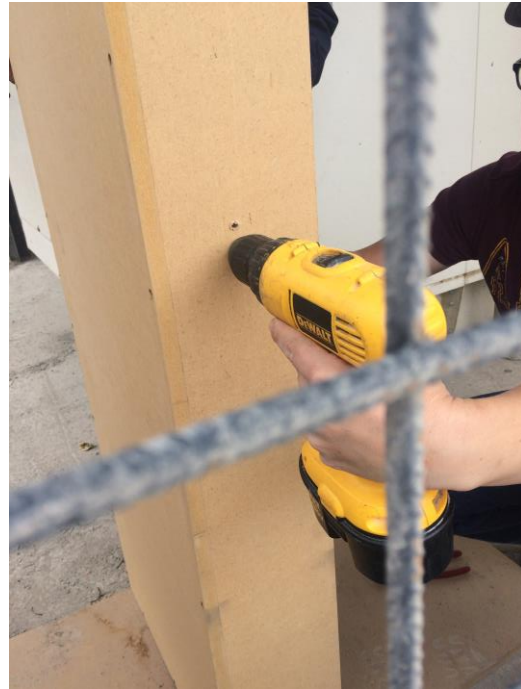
Orificios para el aseguramiento de la estructura de refuerzos
